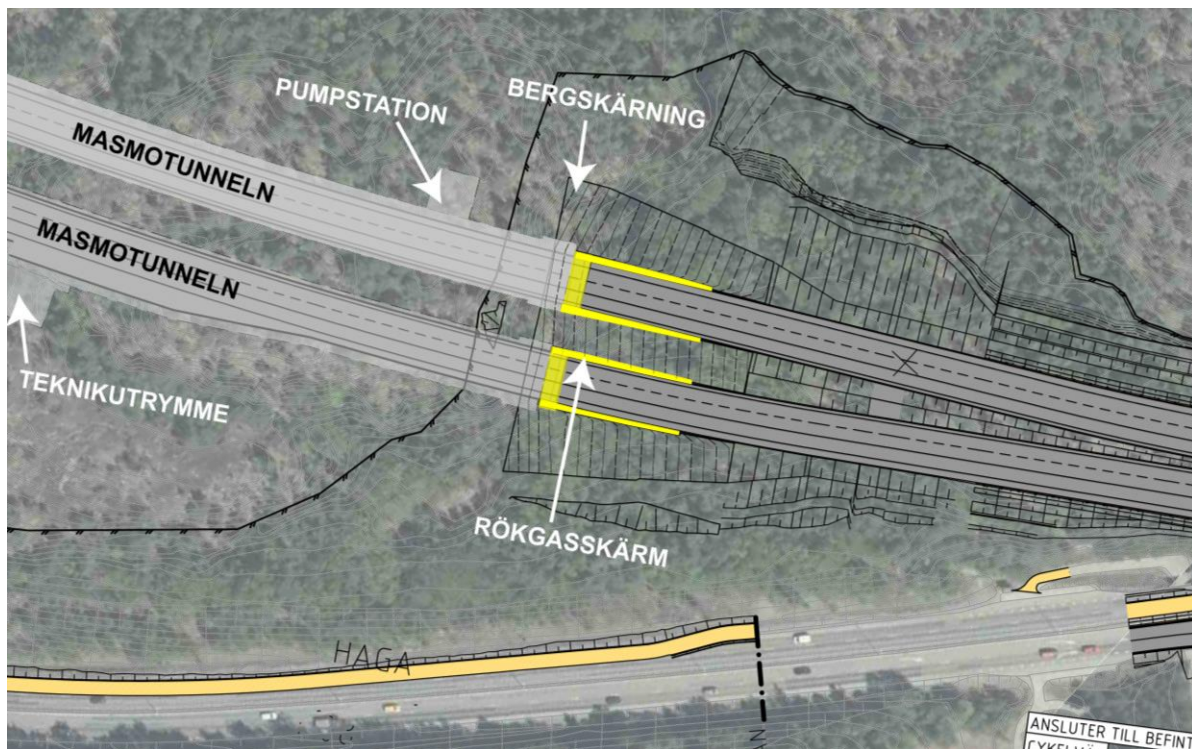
Masmotunneln med betongtunnetapp i mitten av tunneln
